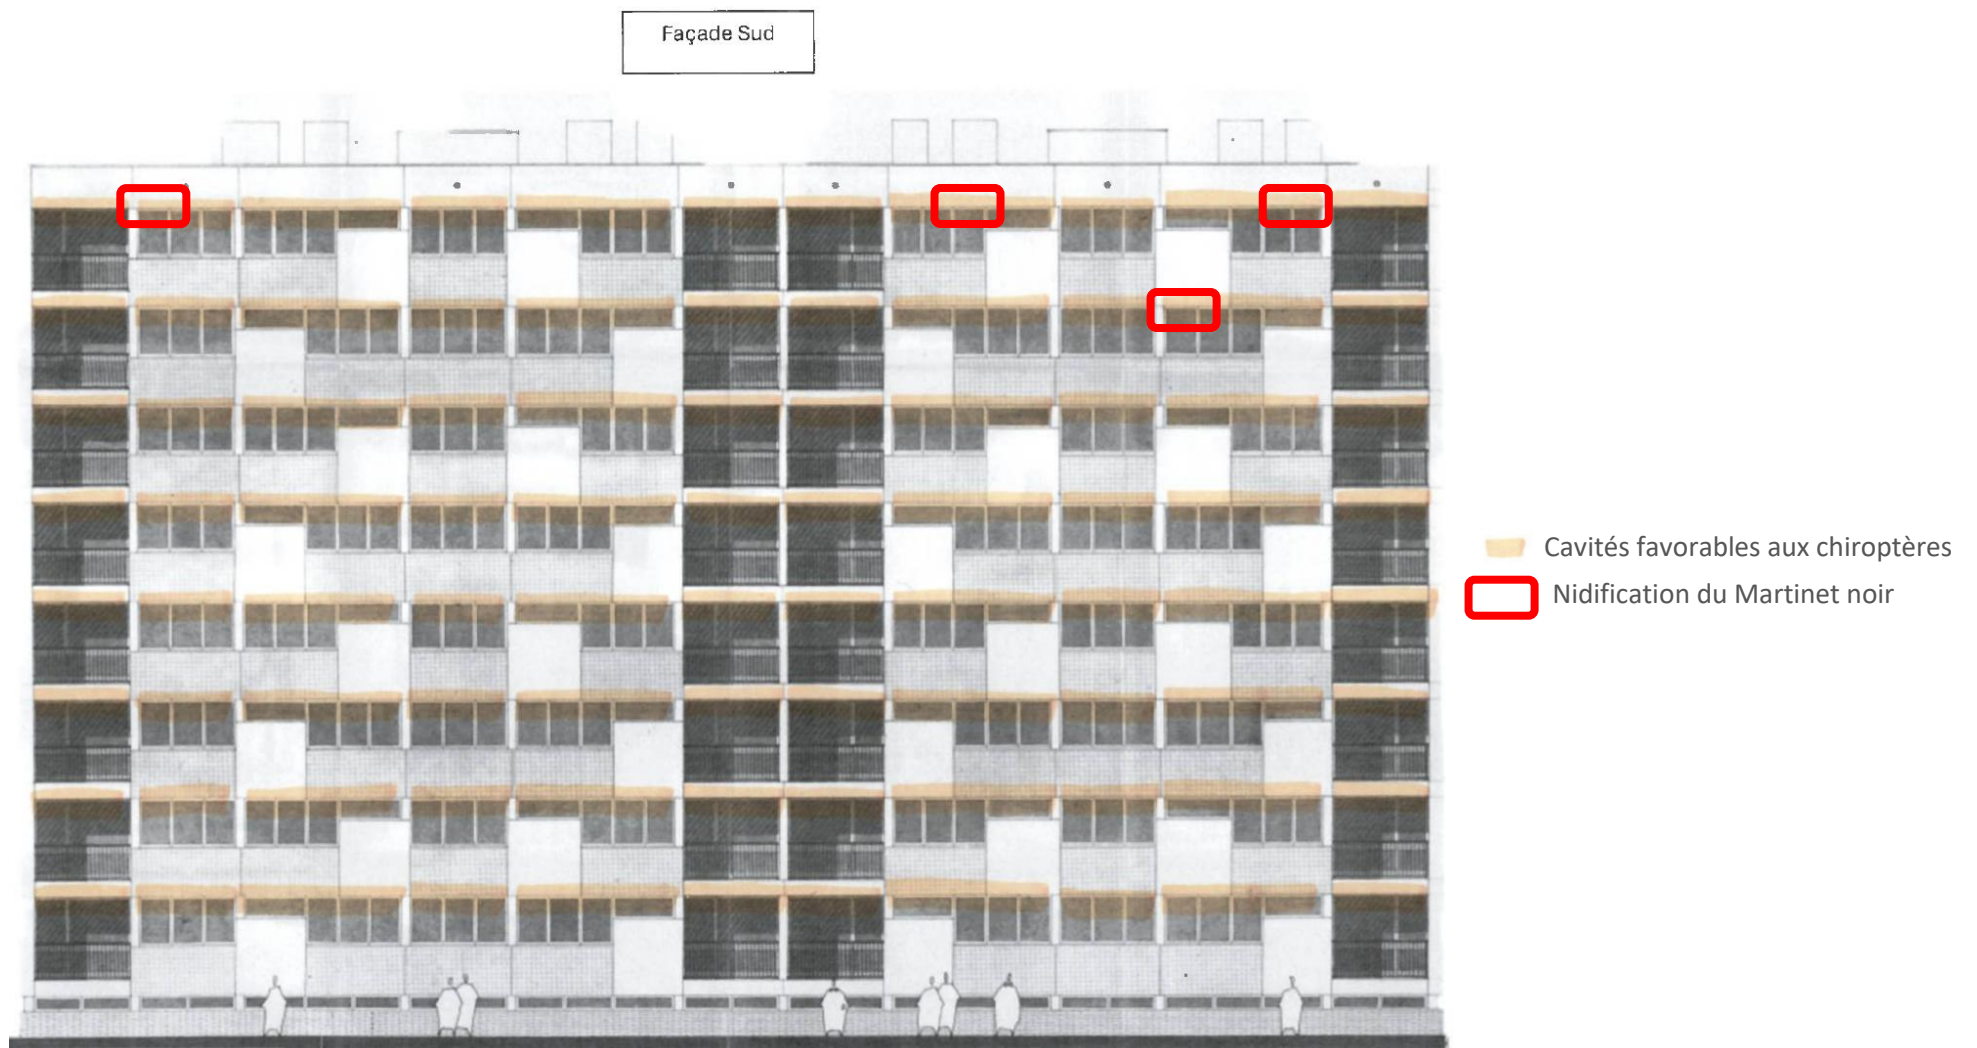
Plan du bâtiment 20 (façade sud) des cavités favorables aux chiroptères et de la nidification des Martinets noirs
